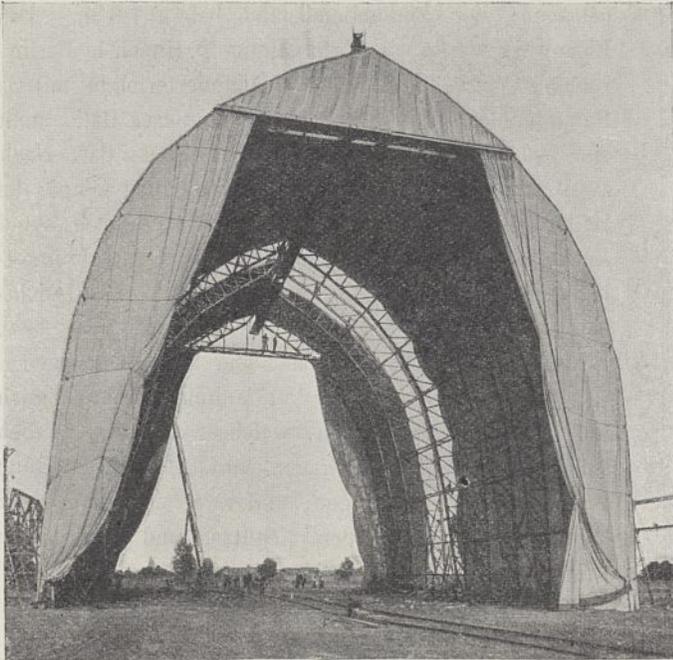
Versetzbare einschiffige Halle in Eisen.
